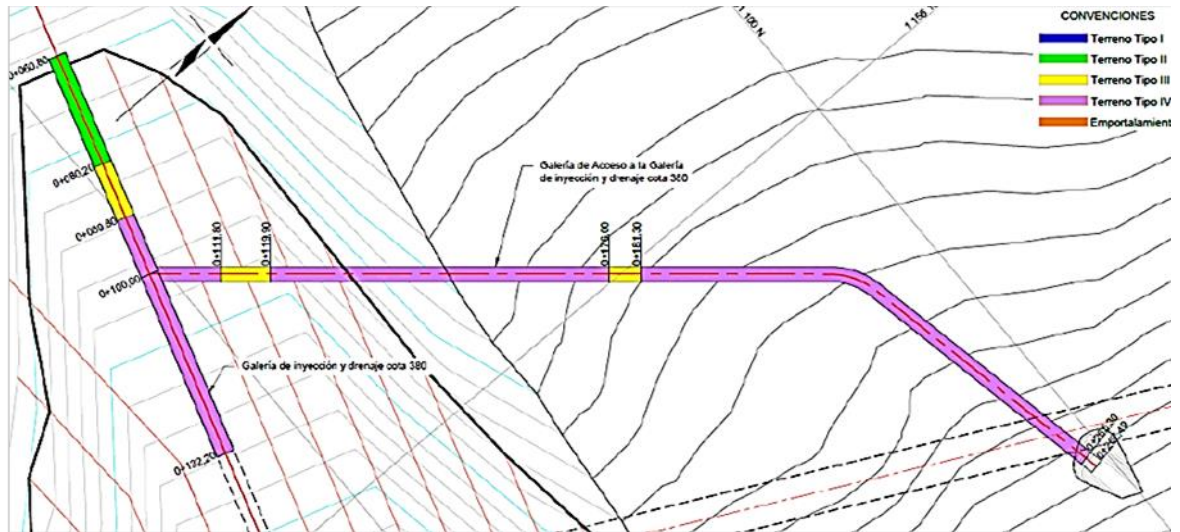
Representación en planta de los tipos de terreno excavados en la GID-380 y su acceso
